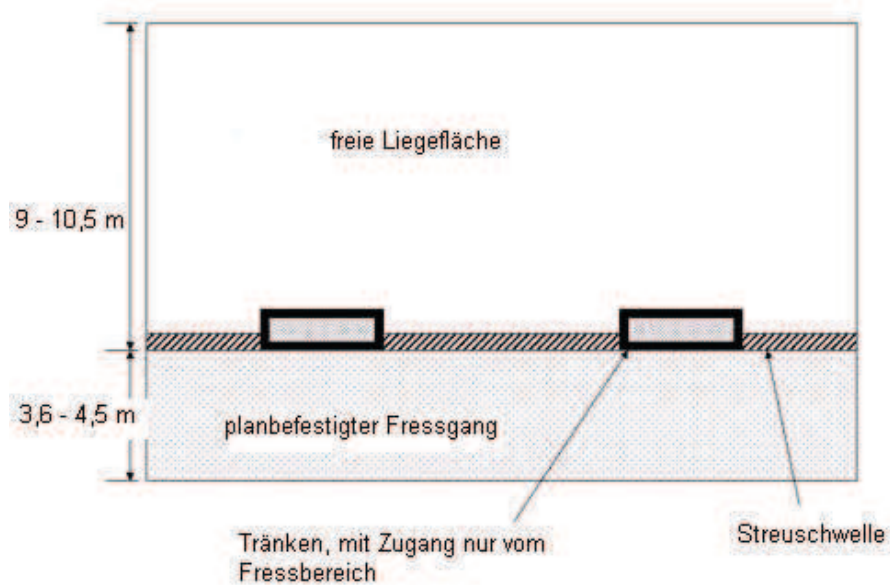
Grundriss für einen Zwei- Raum-Laufstall
